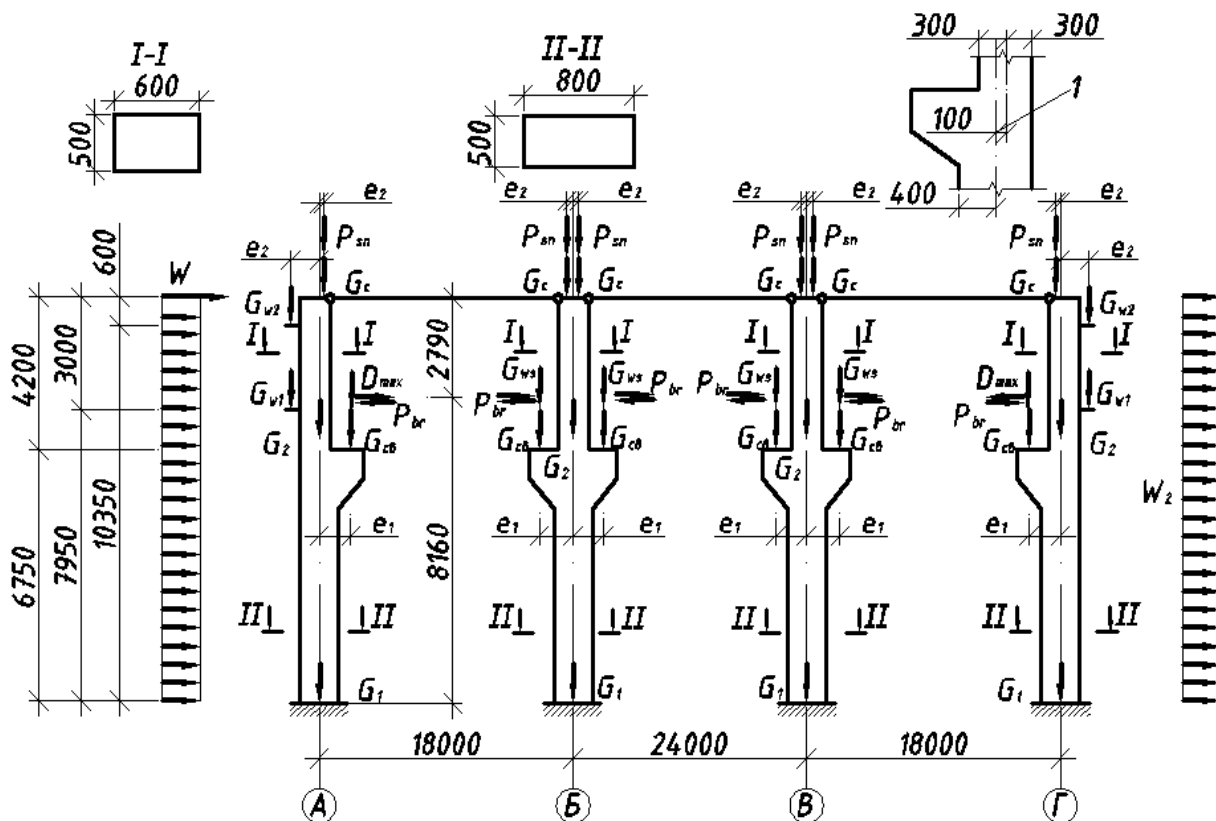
Расчетная схема поперечной рамы и схема нагрузок
